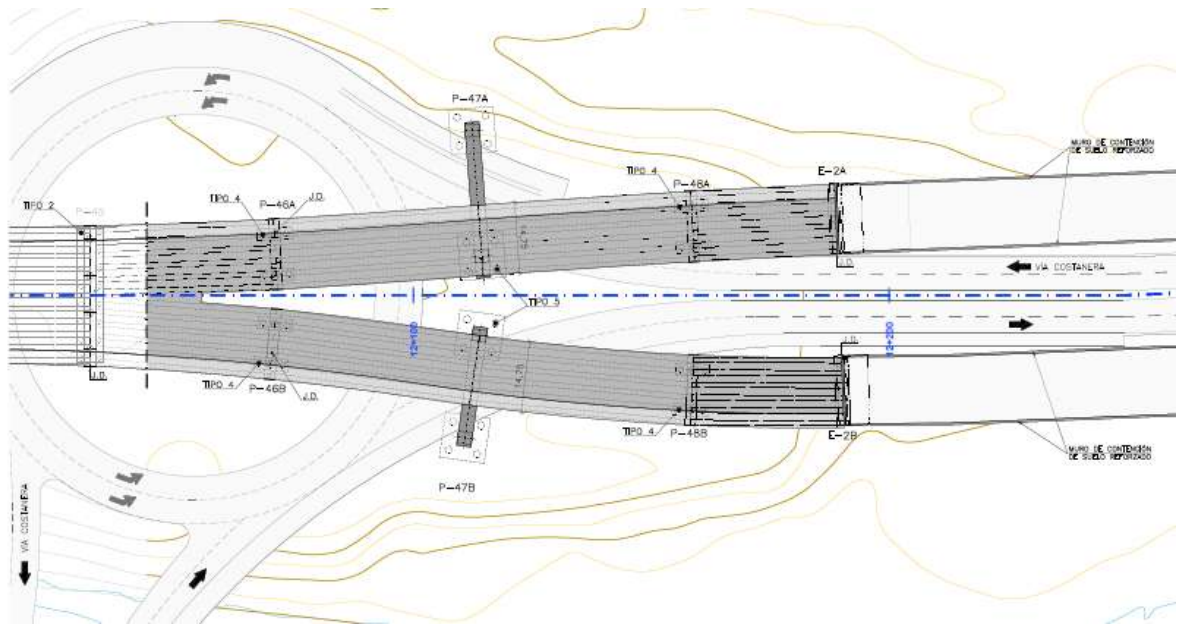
Distribución en planta de pilas en zona de final de enlace con la Avda. Costanera.
